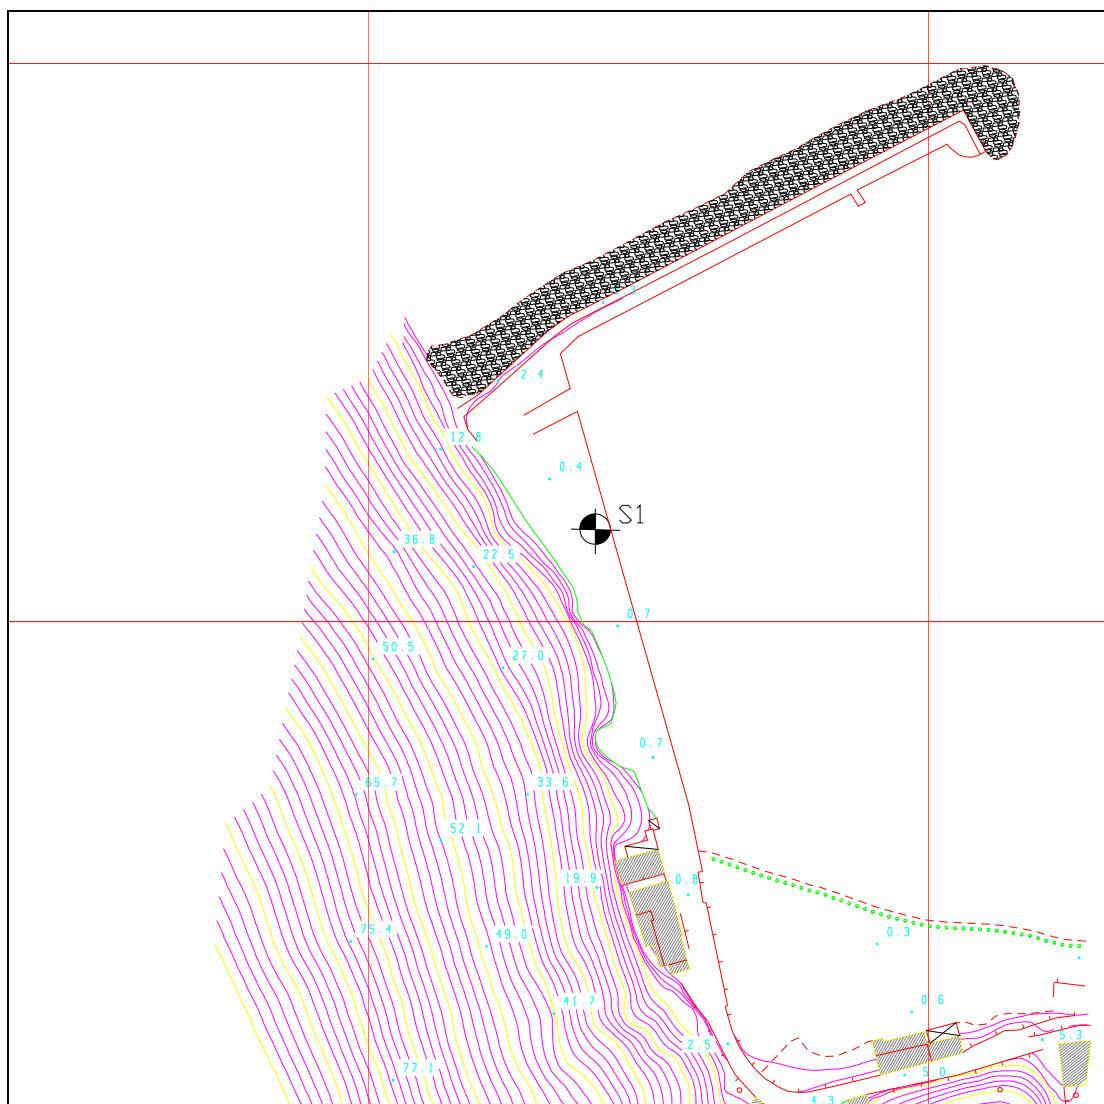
ubicazione planimetrica sondaggio a carotaggio continuo S1
